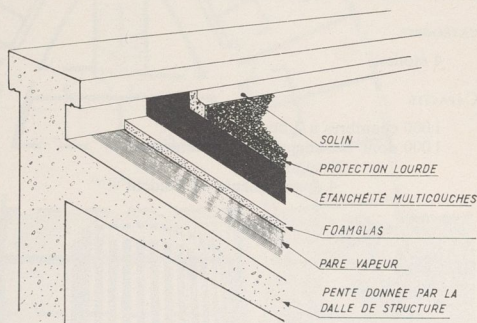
Dispositif d'isolation thermique sans étanchéité d'un toit en terrasse.
